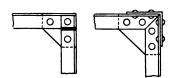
u. 201. Eckverbindungen zweier Winkeleisen. M. 1:20.
